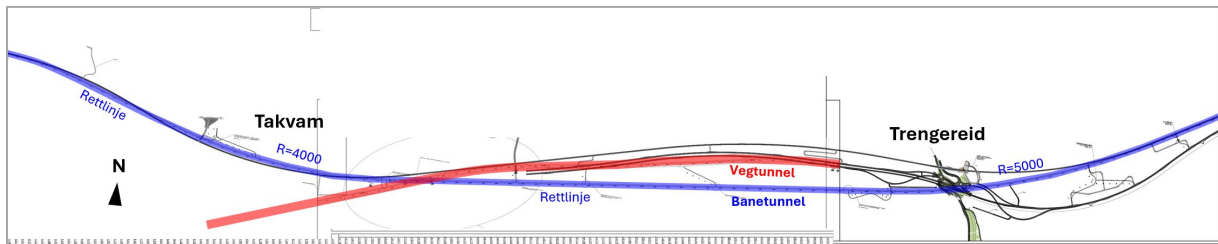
Vedtatt statlig reguleringsplan (2022). Ny jernbanetunnel ligger parallelt med, og nord for planlagt vegtunnel.
